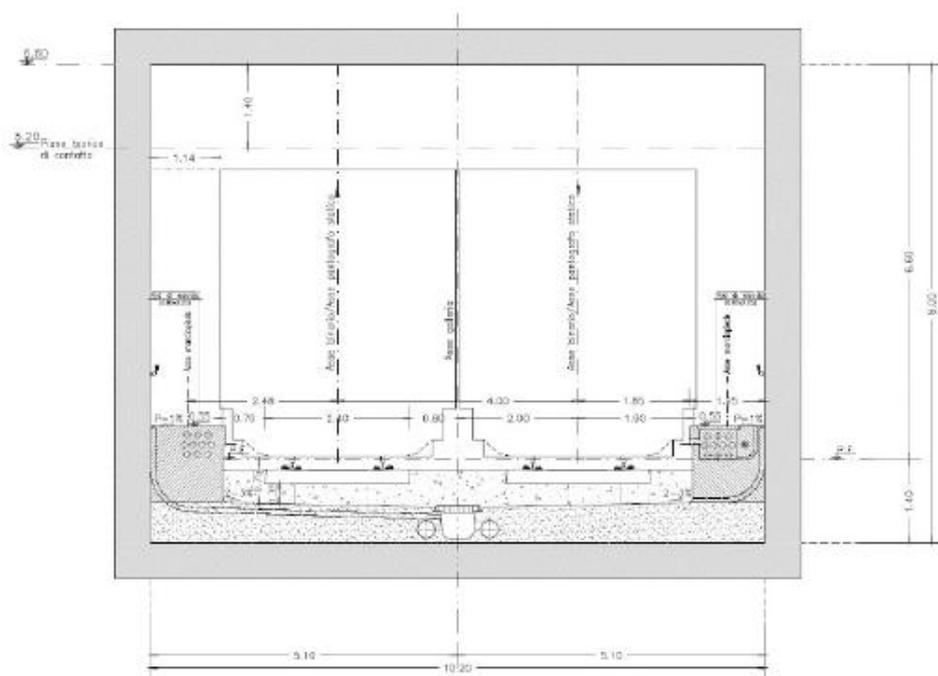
dimensioni interne sezione GA da Manuale di Progettazione RFI
